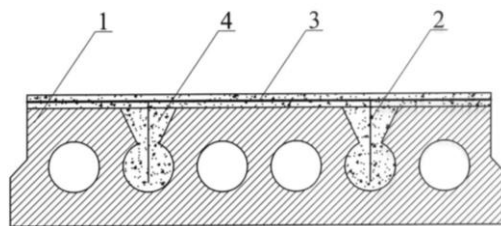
Усиление пустотной плиты перекрытия: 1 - усиливаемая плита; 2 – дополнительный арматурный каркас; 3 – дополнительная арматурная сетка; 4 – бетон усиления
